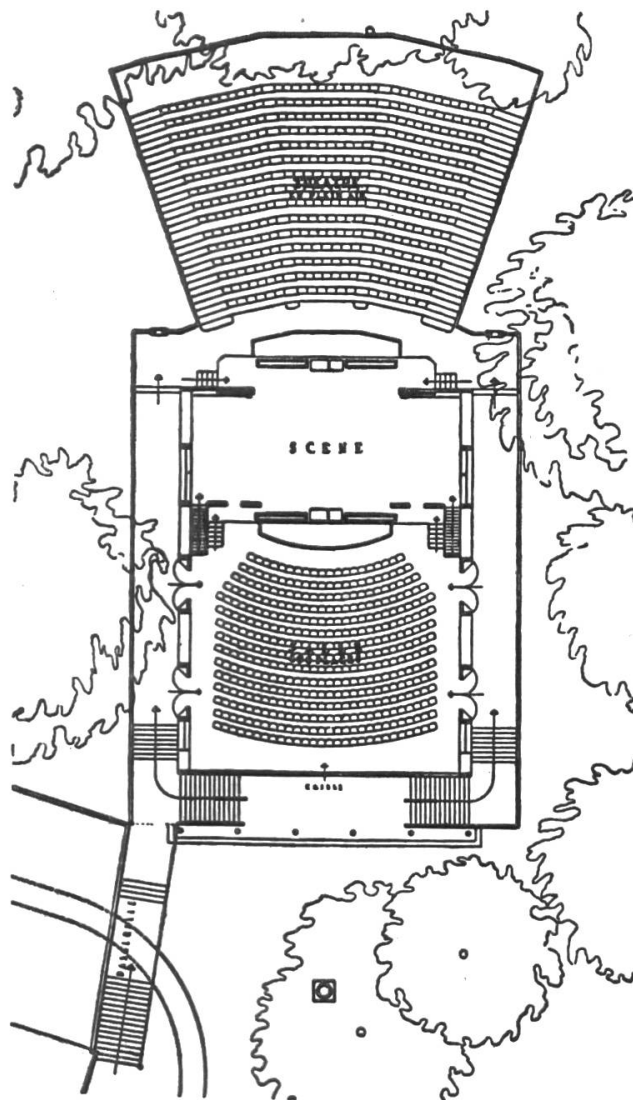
Theater der Landesausstellung Zürich v. Charles Thevenaz. Grundriss
